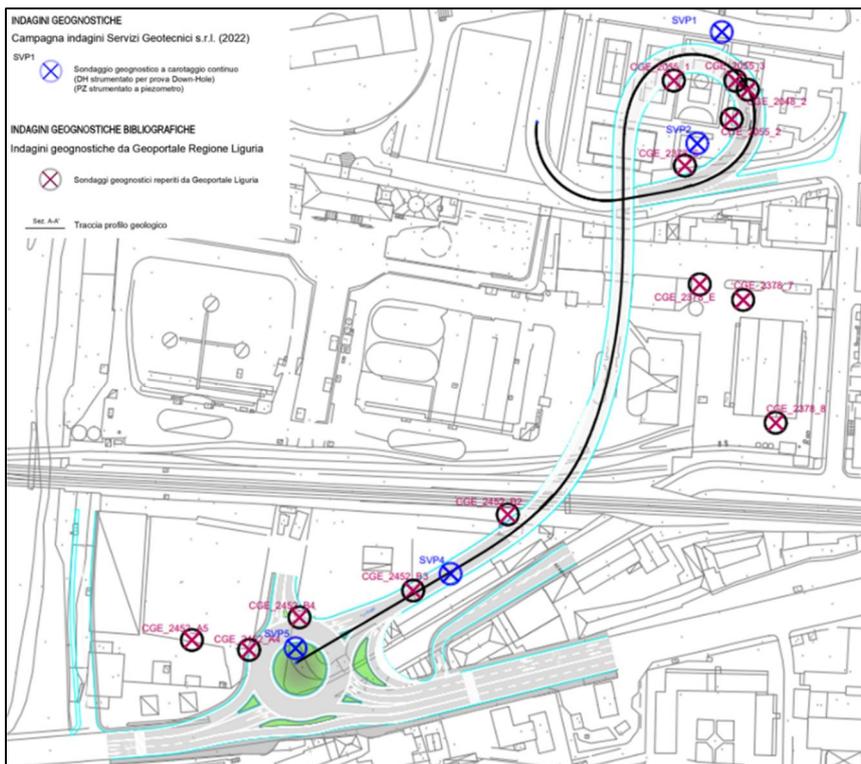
Planimetria di ubicazione delle indagini, di progetto e bibliografiche
